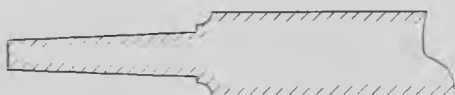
Fylding med særskilt kehling langs med afplatingen.
